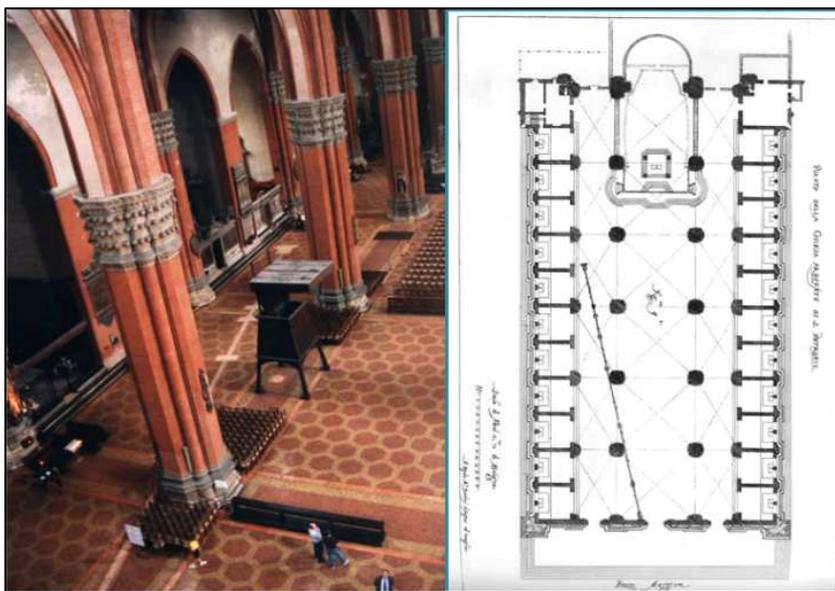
Foto linea meridiana con la pianta originale (dal Web)
